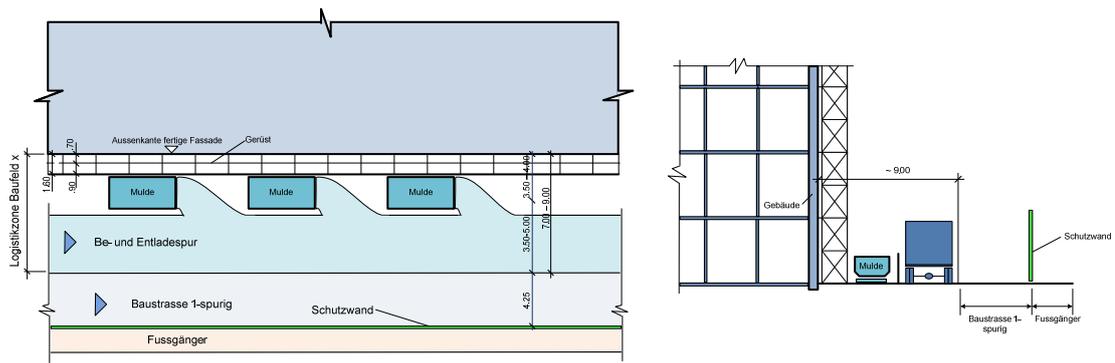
Grundriss und Schnitt eines Entsorgungskonzeptes
